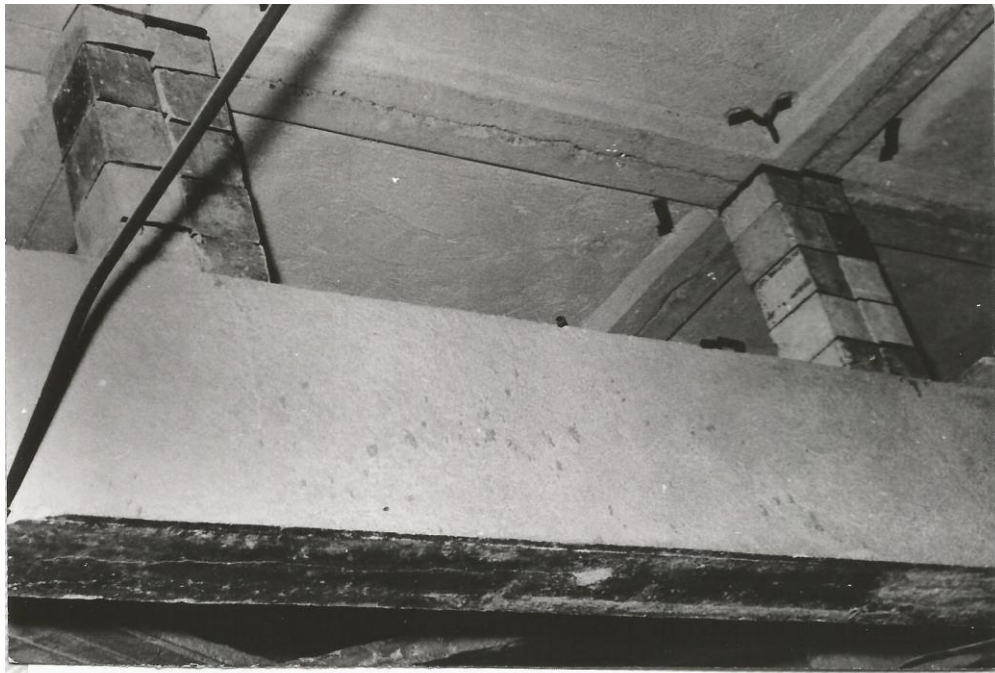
LOSAS PRECOLADAS, EN APOYOS REMOVIBLES PARA PODER BAJARLAS.
